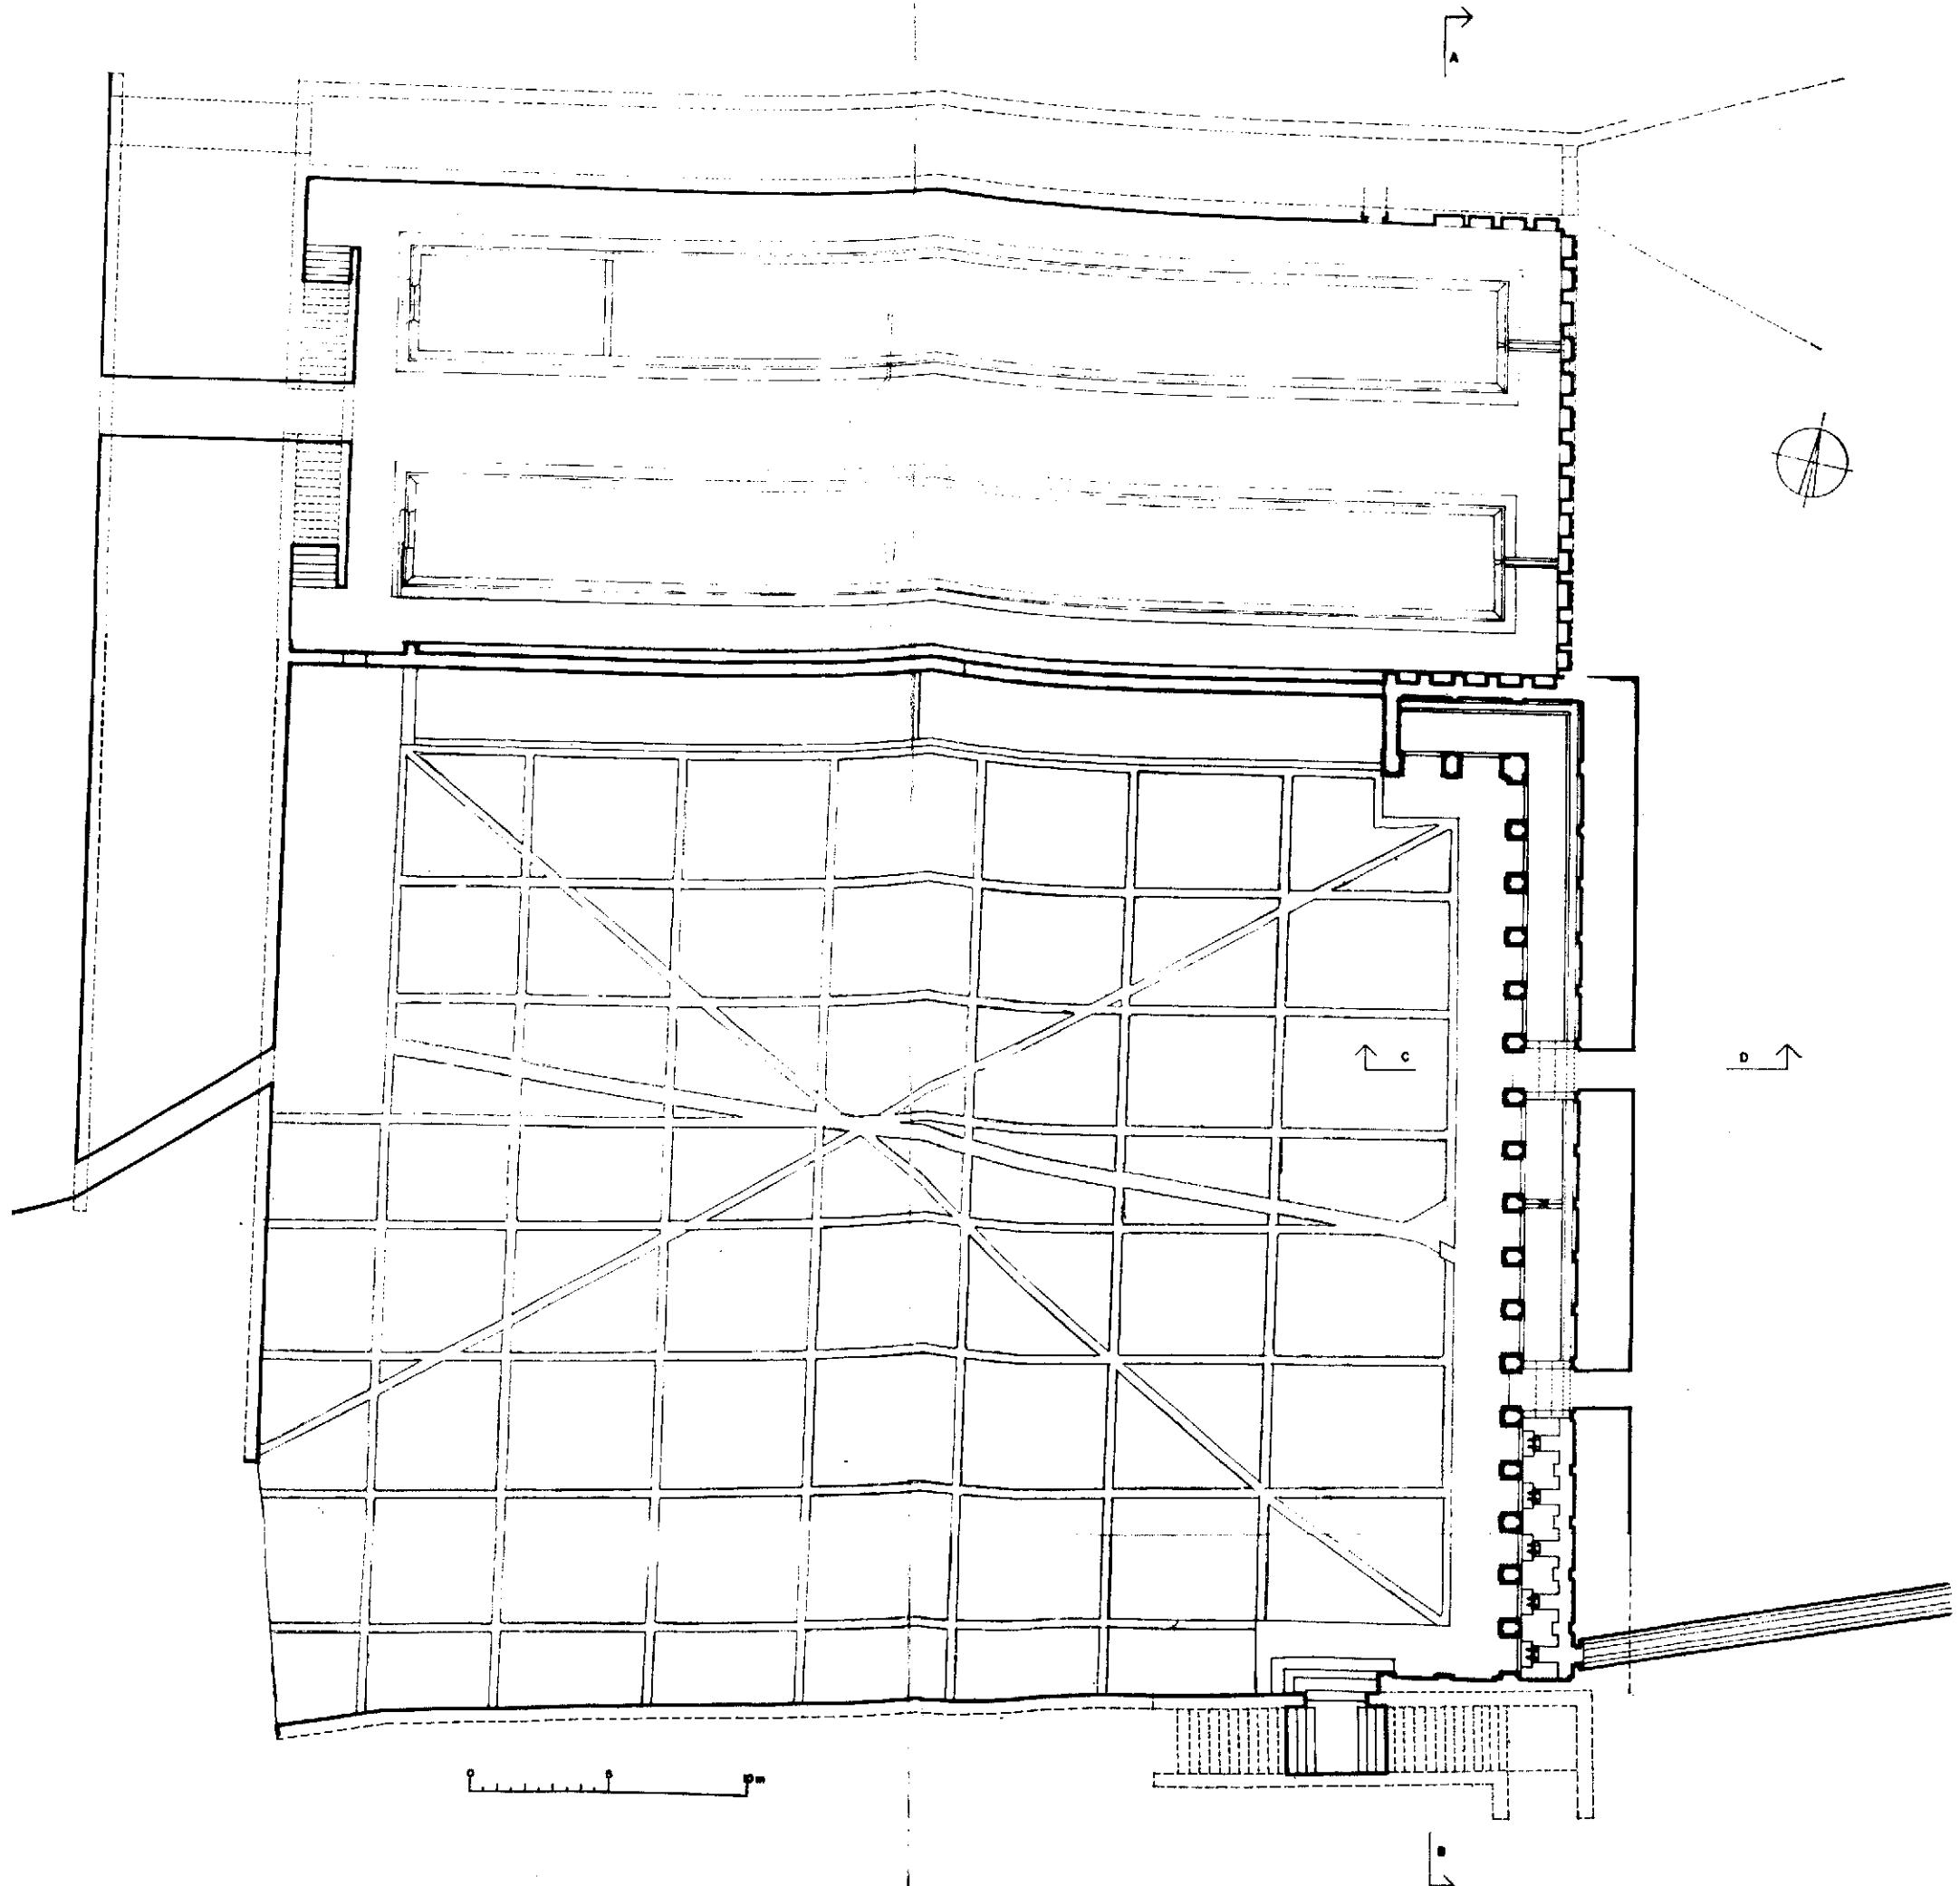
Planta a nivel de las pilas y canales. E. 1 : 250
